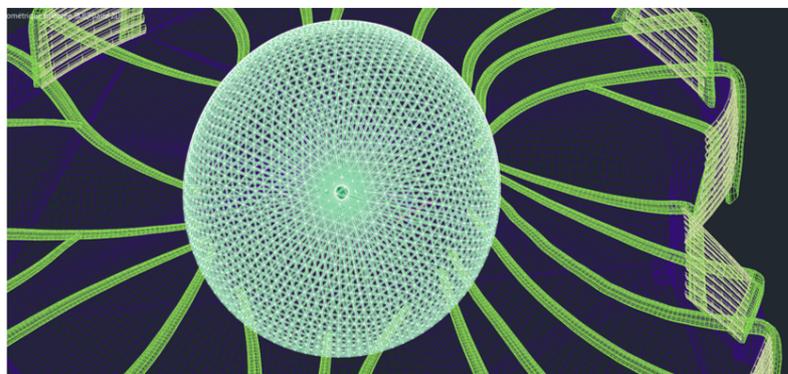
maillage de la structure tridimensionnelle du dôme du projet
